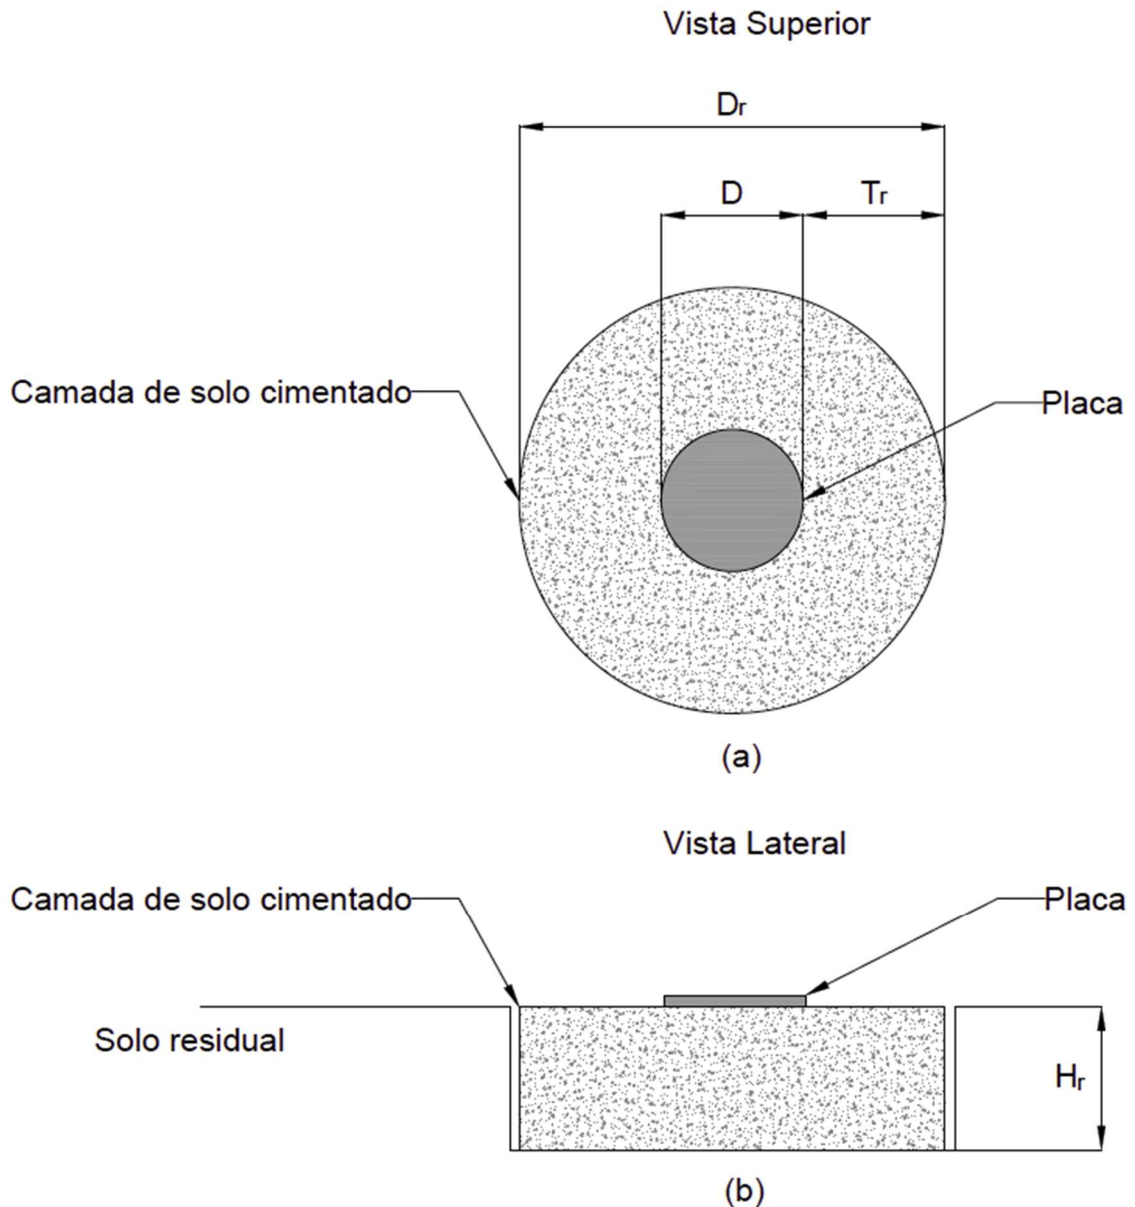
2: Esquema da prova de carga em campo: (a) secção transversal; (b) vista em planta.
